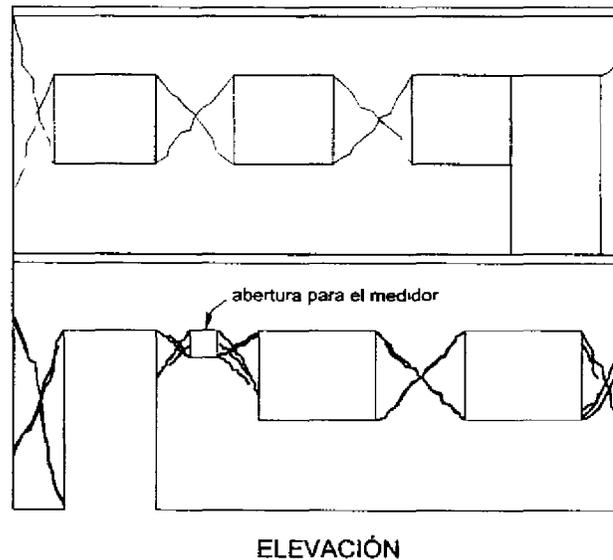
Geometría y patrón típico del agrietamiento en muros de fachada con aberturas
